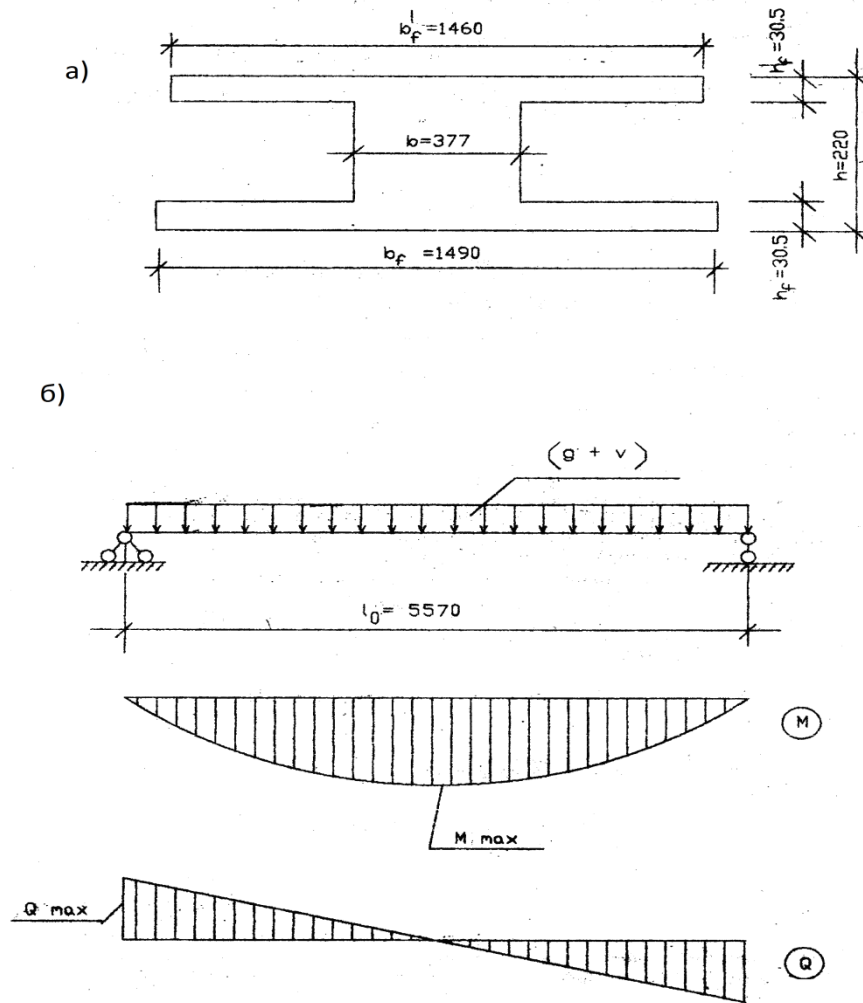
а) Розрахунковий перетин плити; б) Розрахункова схема і епюри зусиль.
